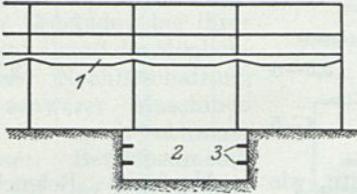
Werkstatt mit Grube zum Zusammenbau hoher Maschinen.
